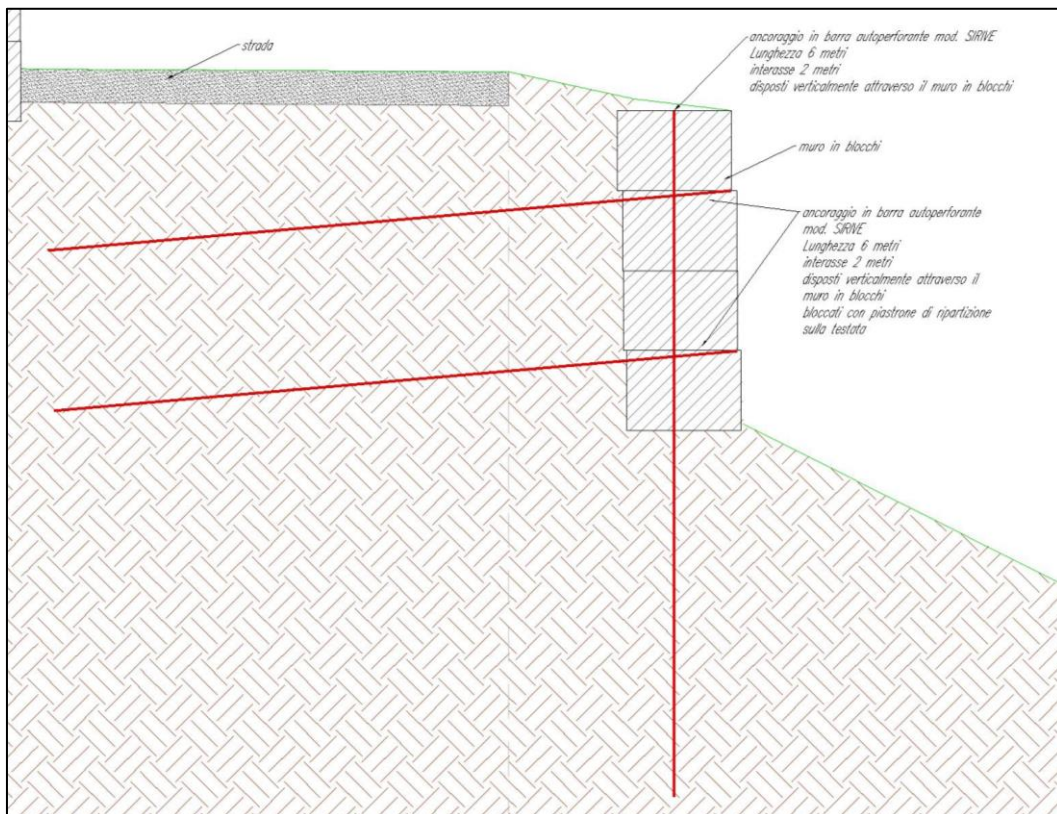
Sezione tipo dell'intervento nel sito "Pedalto Ovest"
